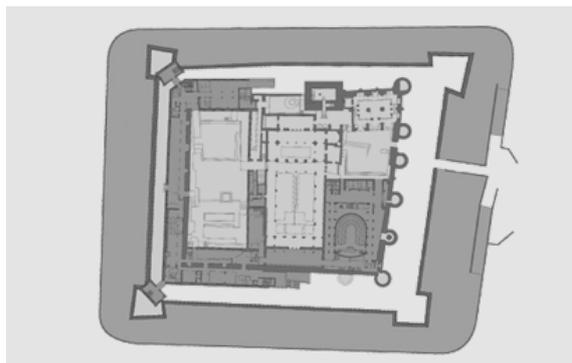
Grundrissplan der Festung der Aljafería nach europäischer Bauweise und Vorbildern
